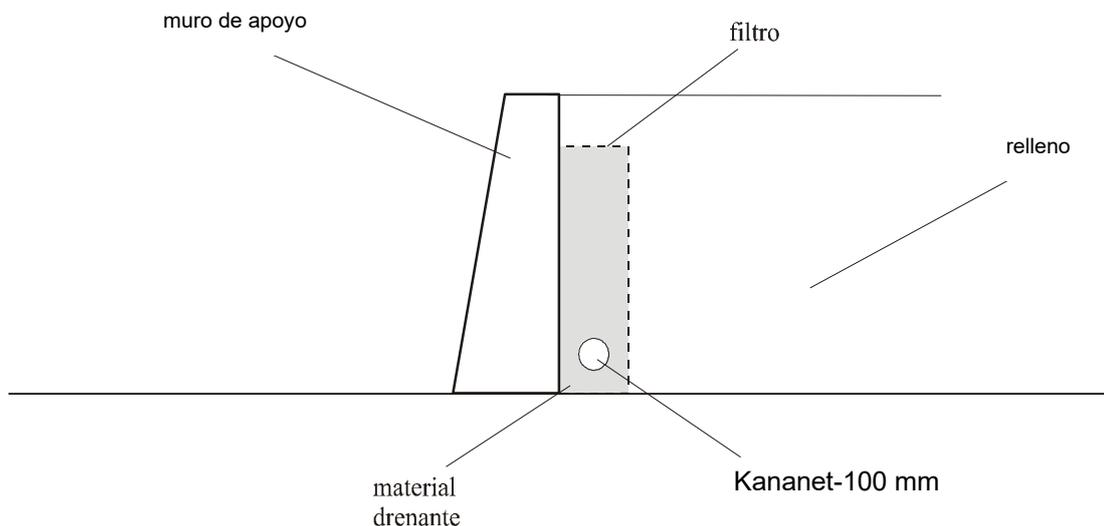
Cortina drenante interceptora, detrás del muro de apoyo.
